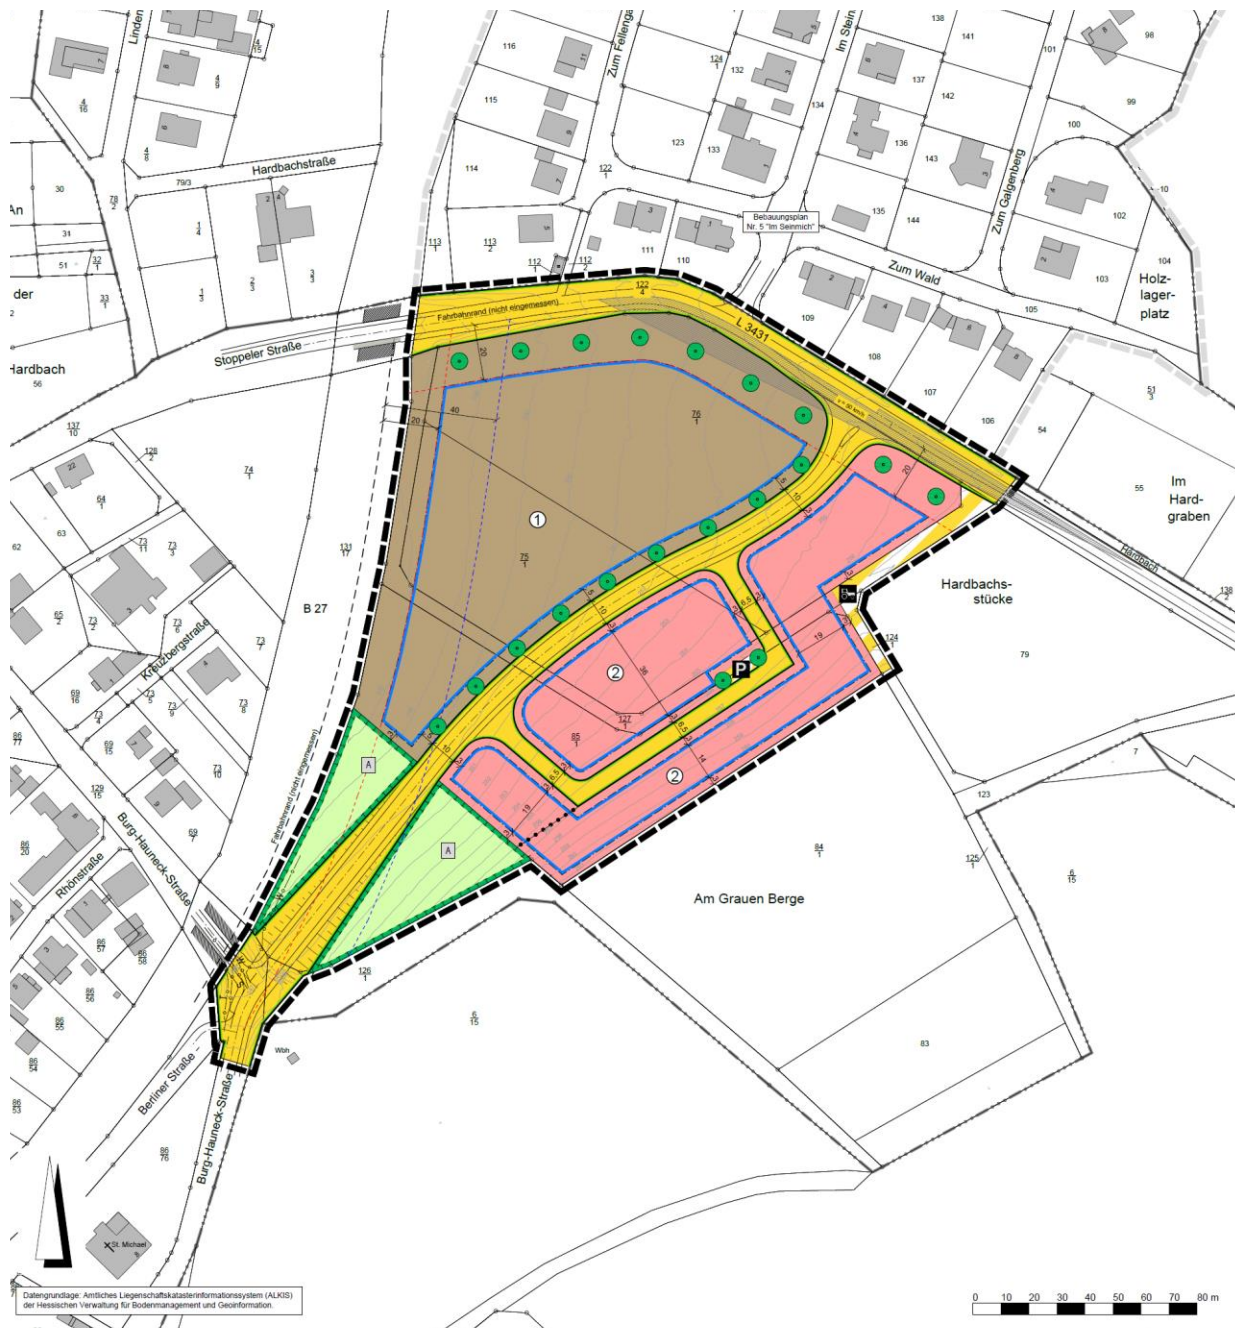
Bebauungsplan „Östlich der Bundesstraße B27“
